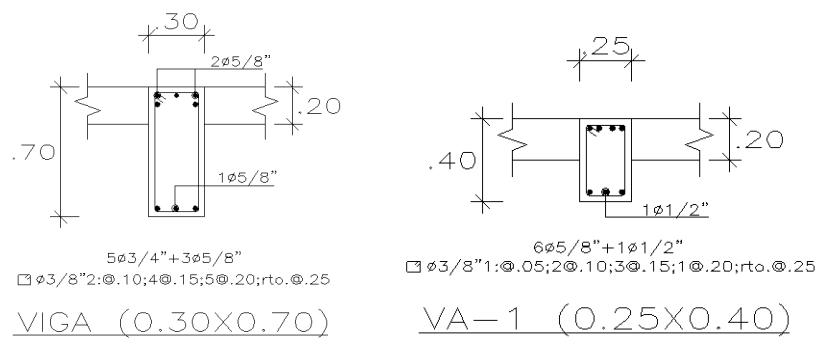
Detalle de vigas de concreto armado (colegio 780 antiguo).
